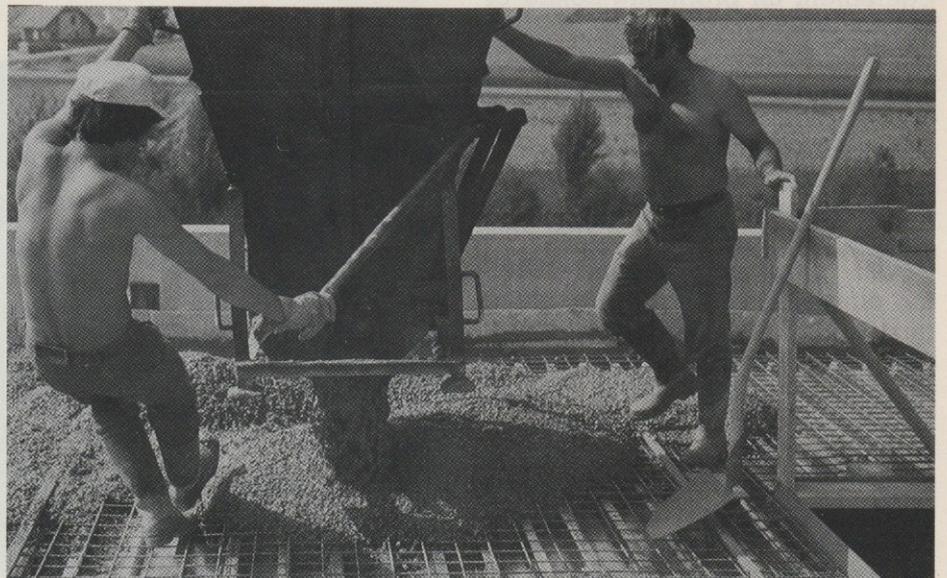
Dalle mixte en cours de bétonnage. On remarque la charge temporaire provoquée par les ouvriers et par l'accumulation locale du béton frais.
